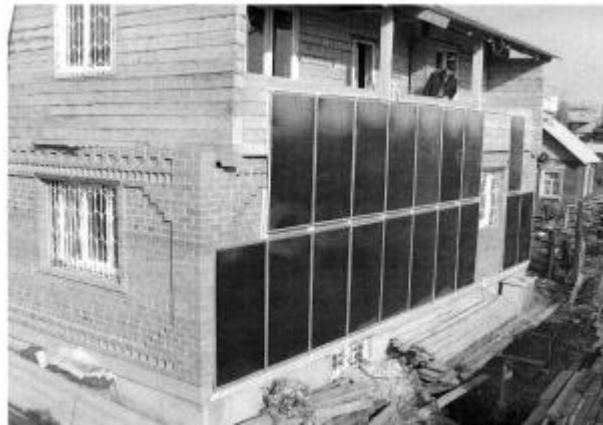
Будинок з панелями фотоелементів на вертикальному фасаді
